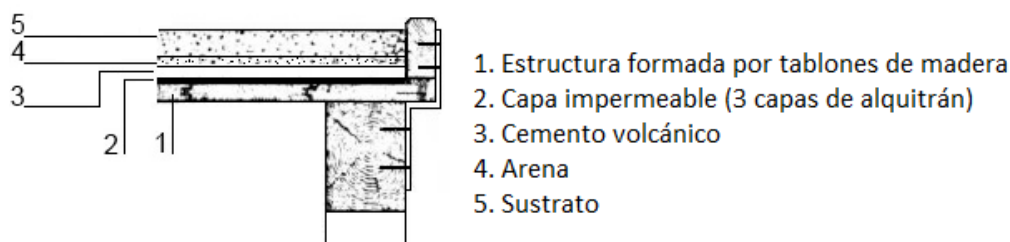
Detalle constructivo cubierta de Karl Rabitz.
